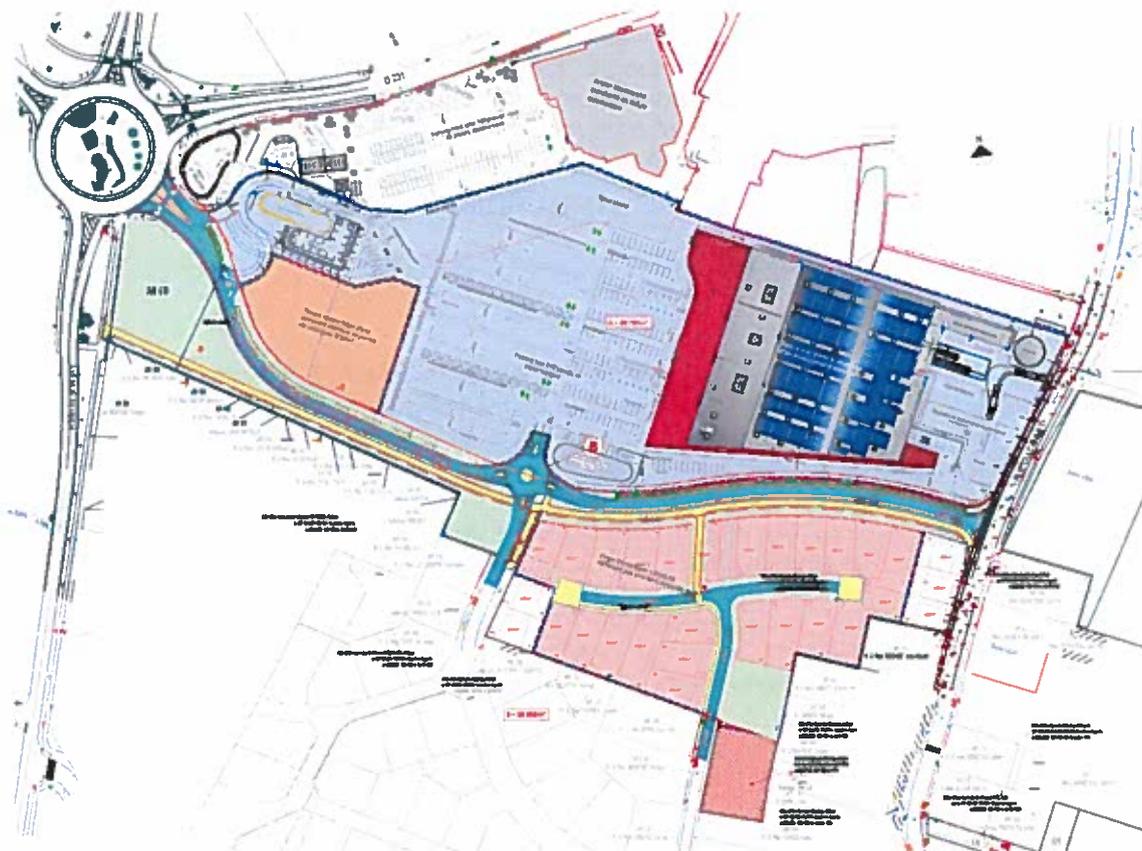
Plan masse du projet (Source : Étude d'impact)
